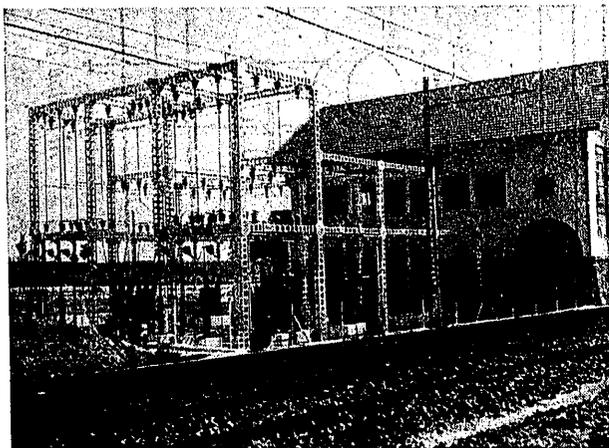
ª — Vista de la subestación por el lado del puesto exterior.
